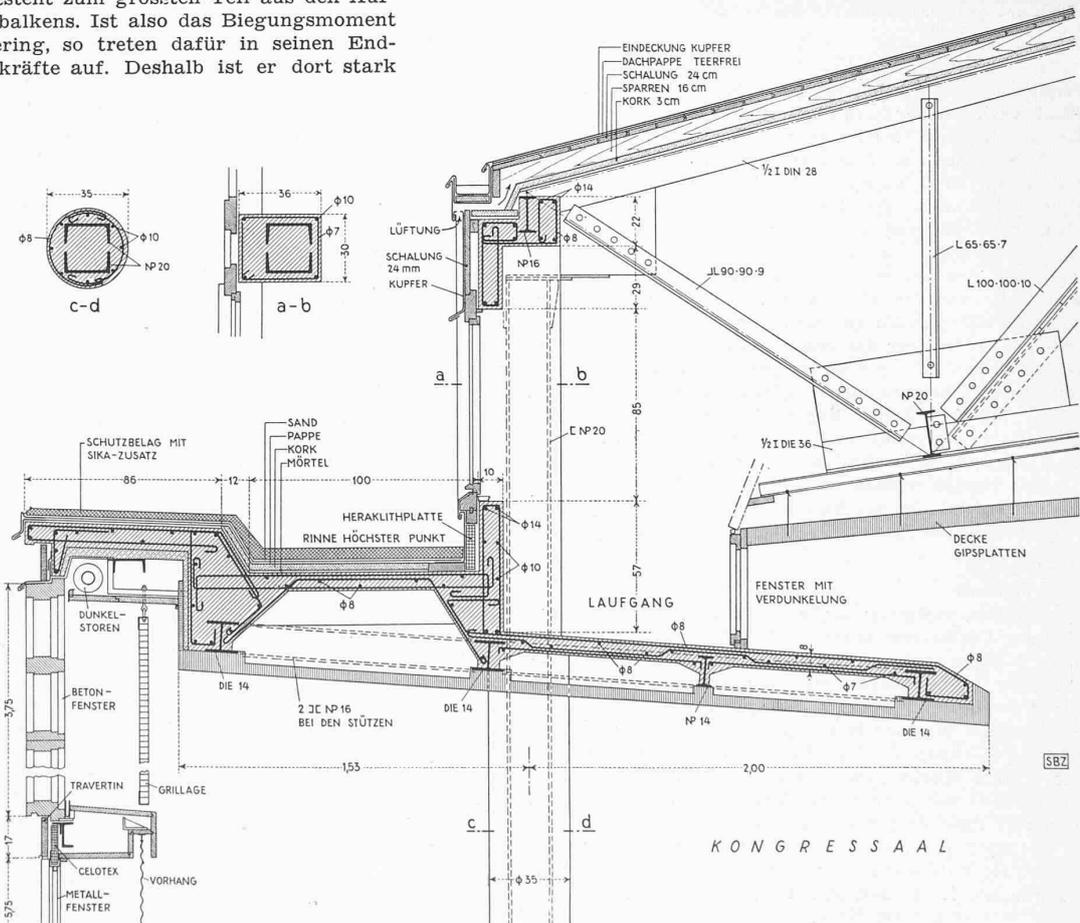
Kongress-Saal. Einzelheiten von Aussenwand, Säule, Versteifungsplatte, Dachausbildung. — Masstab 1 : 30
